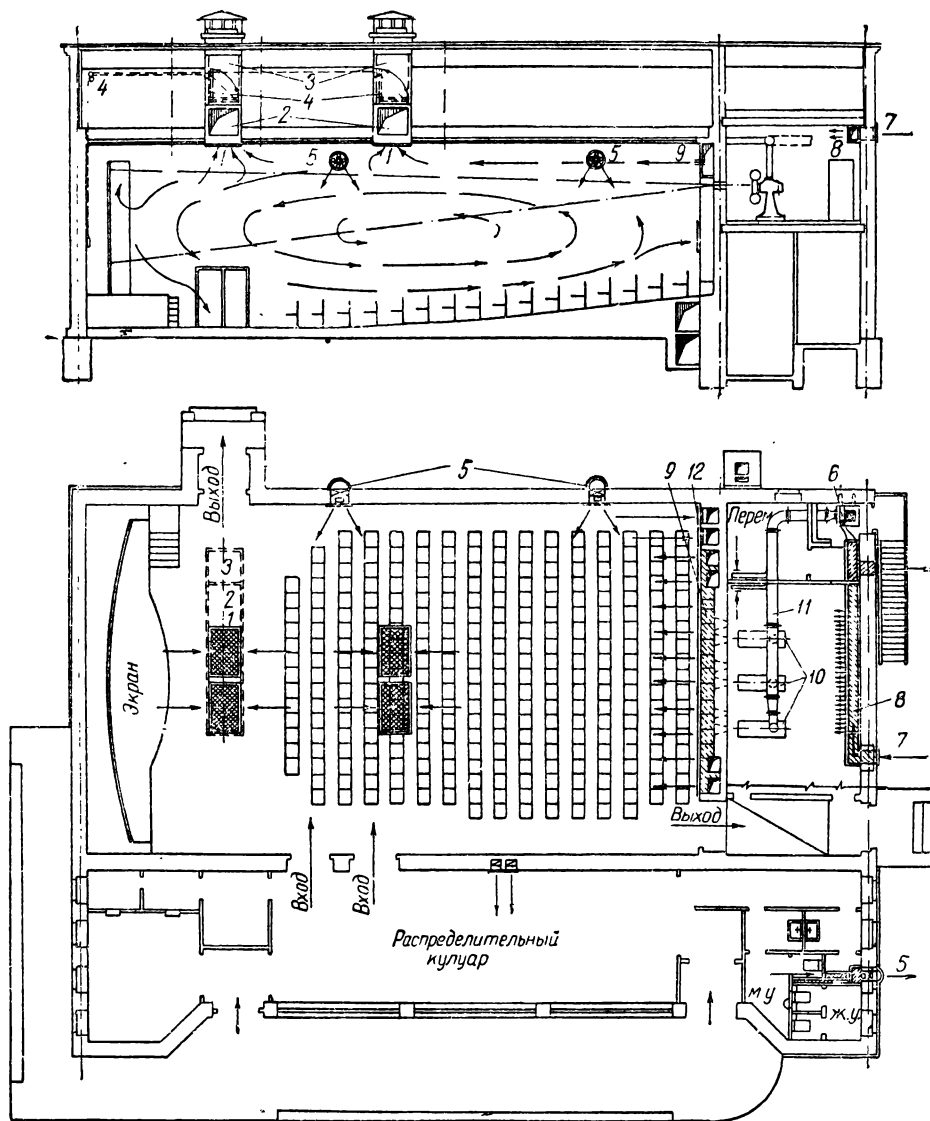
Схема вентиляции зрительного зала на 300 мест:
